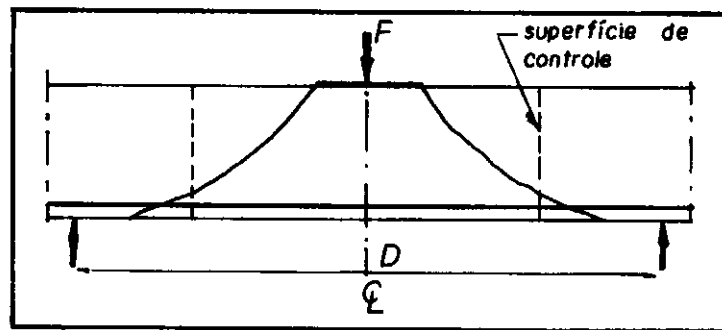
Mecanismo de ruptura da laje de concreto submetido a punção.
